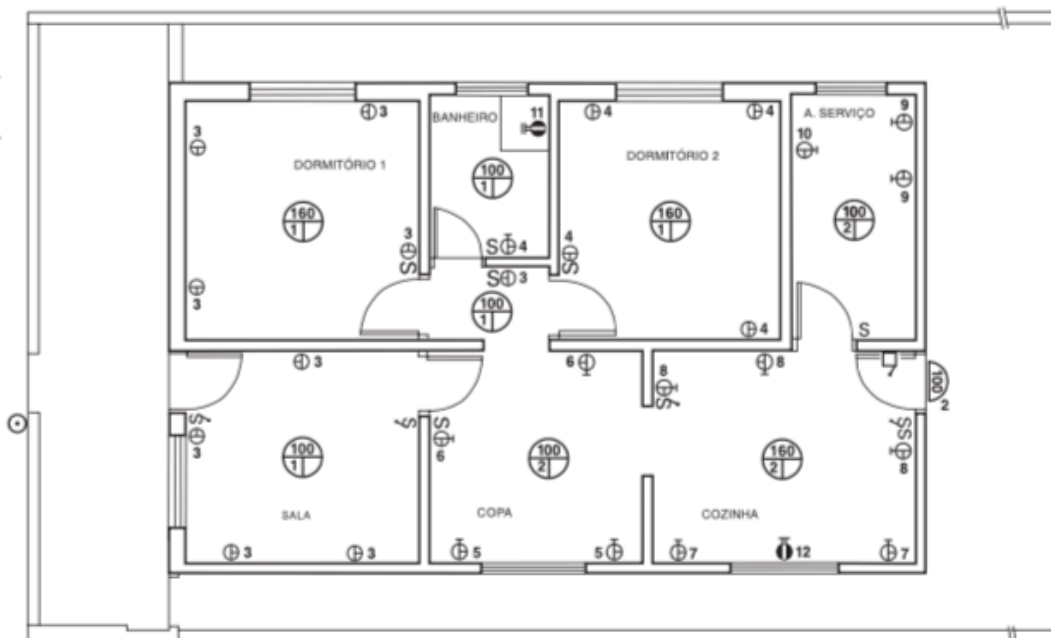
Exemplo de locação dos elementos sobre a planta baixa.
